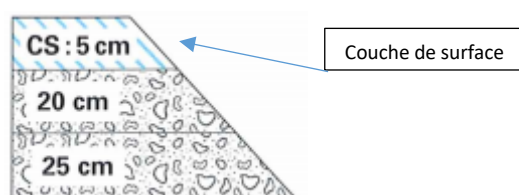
Structure de chaussée envisageable sur le site projet : structure GNT / GNT
